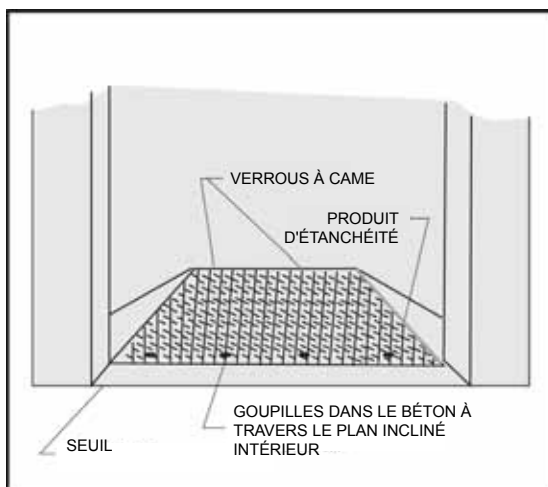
PLAN INCLINÉ INTÉRIEUR
